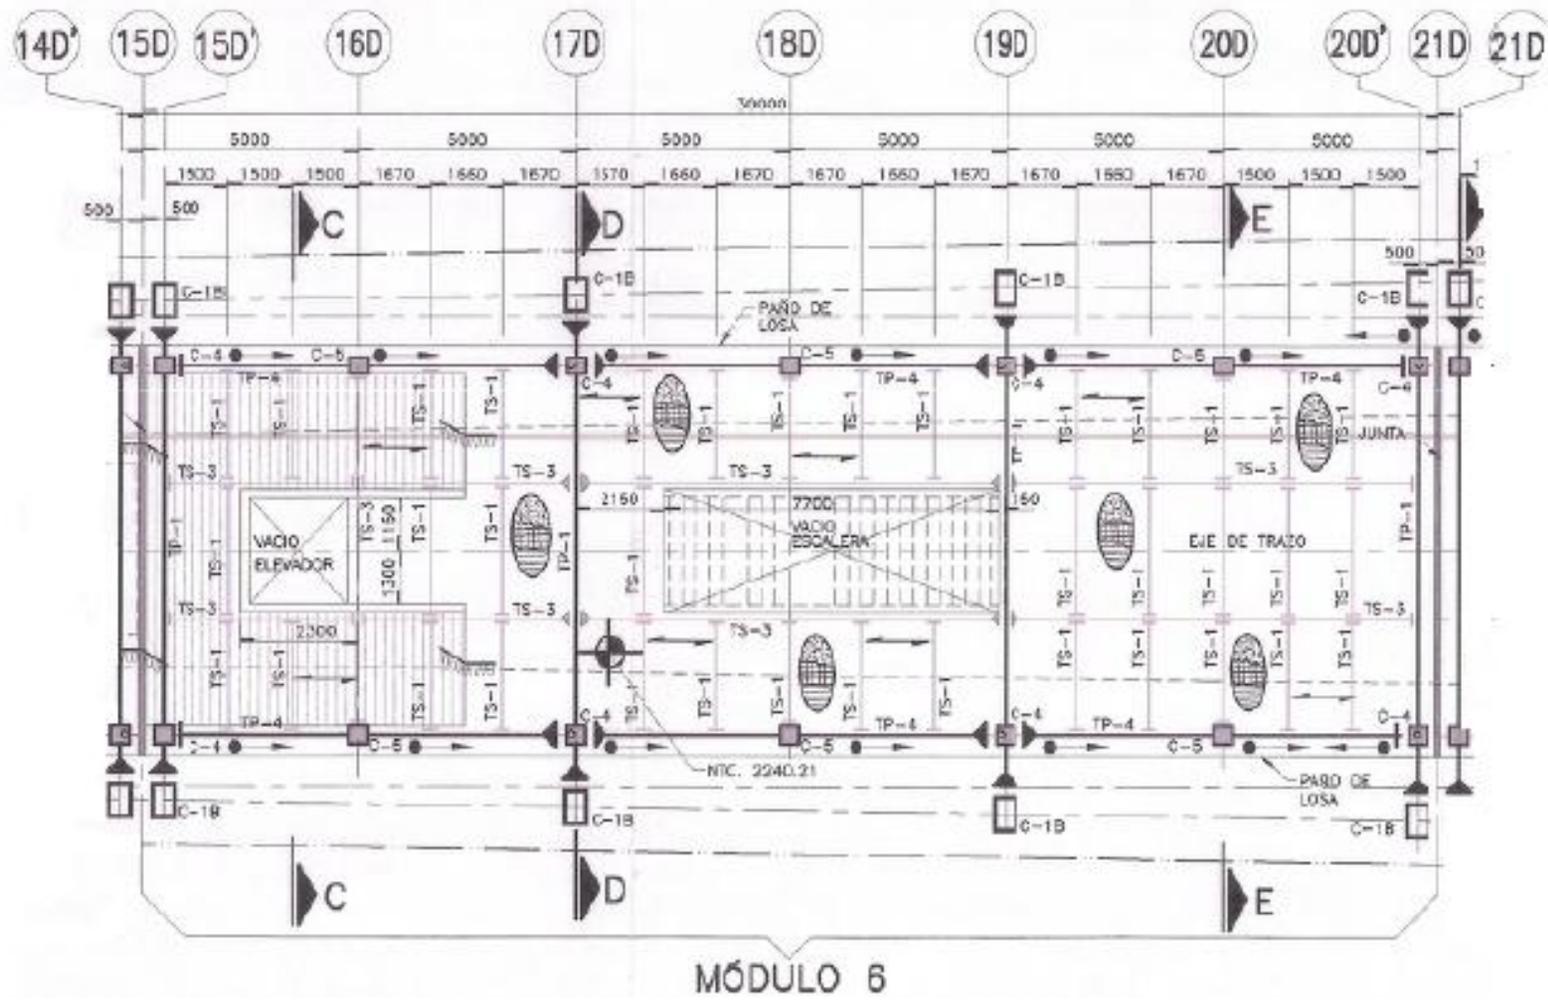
Planta de estructuración nivel pasarela, módulo 6.
